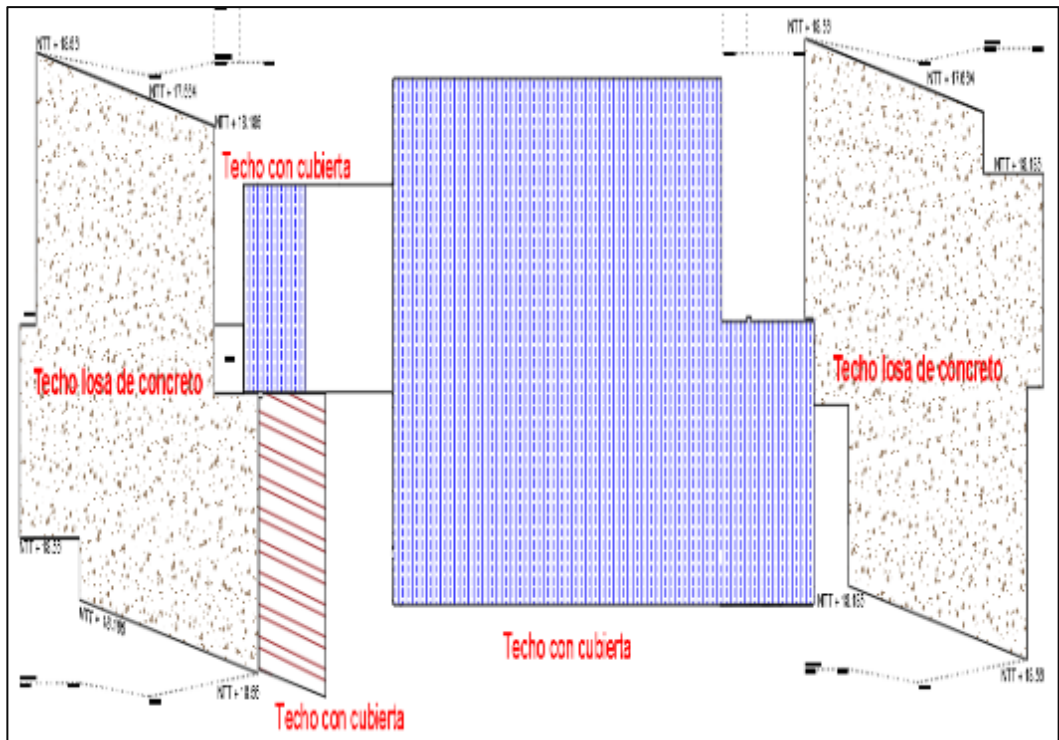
Vista en planta del techo del pabellón I- FIUPLA
